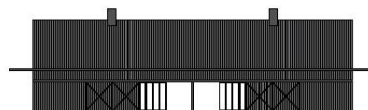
Restaurangens gestaltning (Arkitema Architects)
